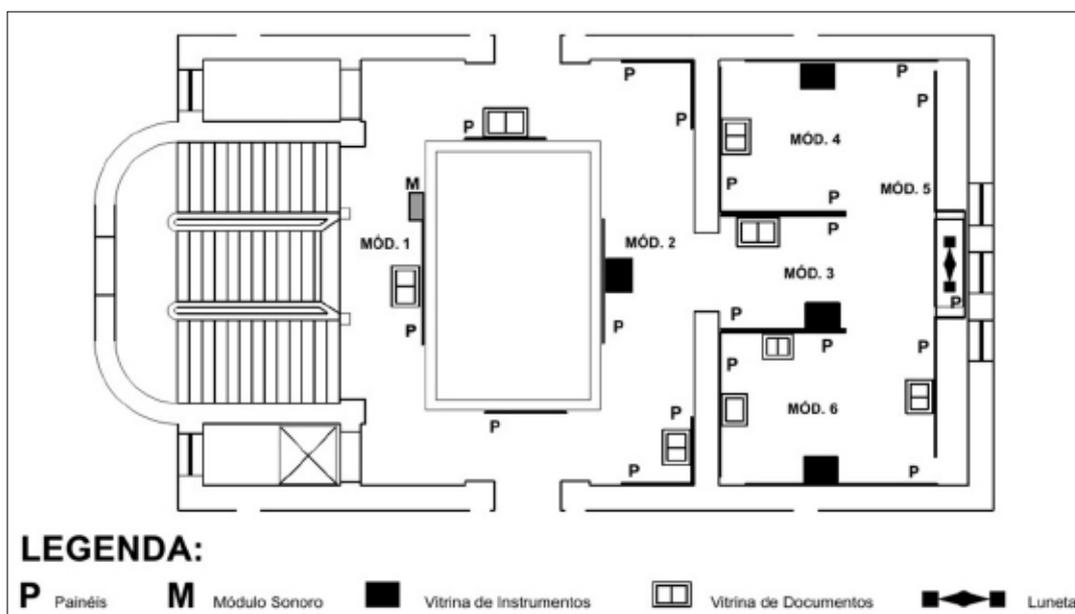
Planta baixa do pavimento do prédio sede do museu, onde a exposição foi montada, com a distribuição dos elementos utilizados (Acervo MAST).
